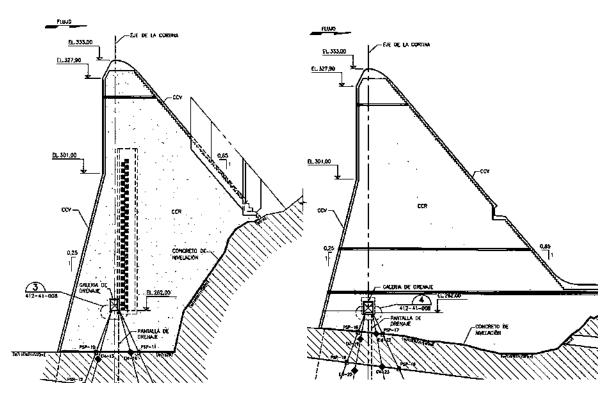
IV.2 Vista de la ubicación de la galería de drenaje.
